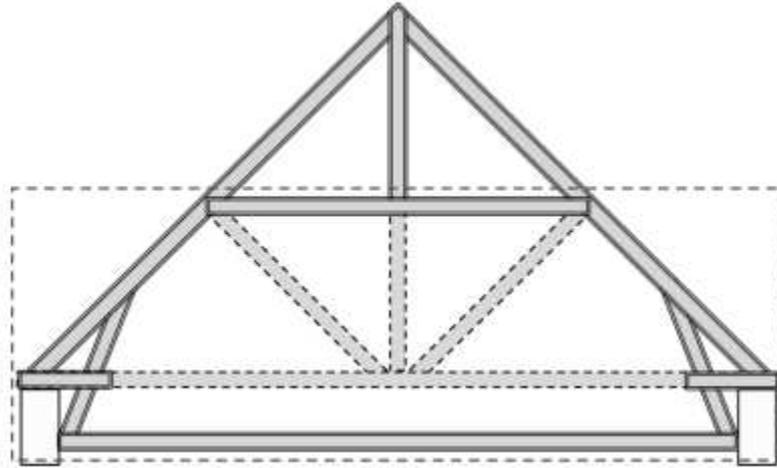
exemple de dégagement de la charpente et d'abaissement du plancher
